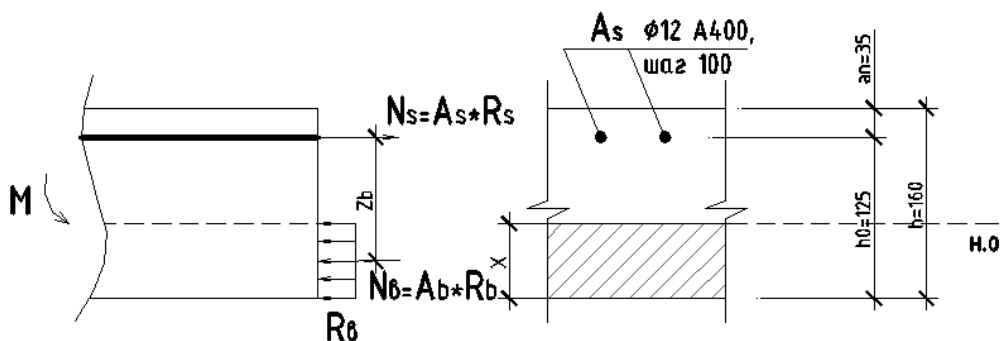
Схема внутренних усилий плиты на опоре
